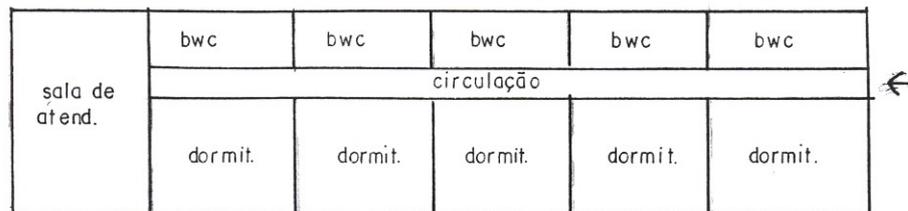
Croqui esquemático da Planta Baixa da nova sede.
